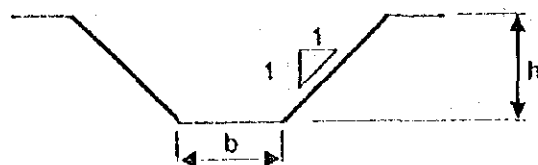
Section standard des canaux secondaires d'irrigation
